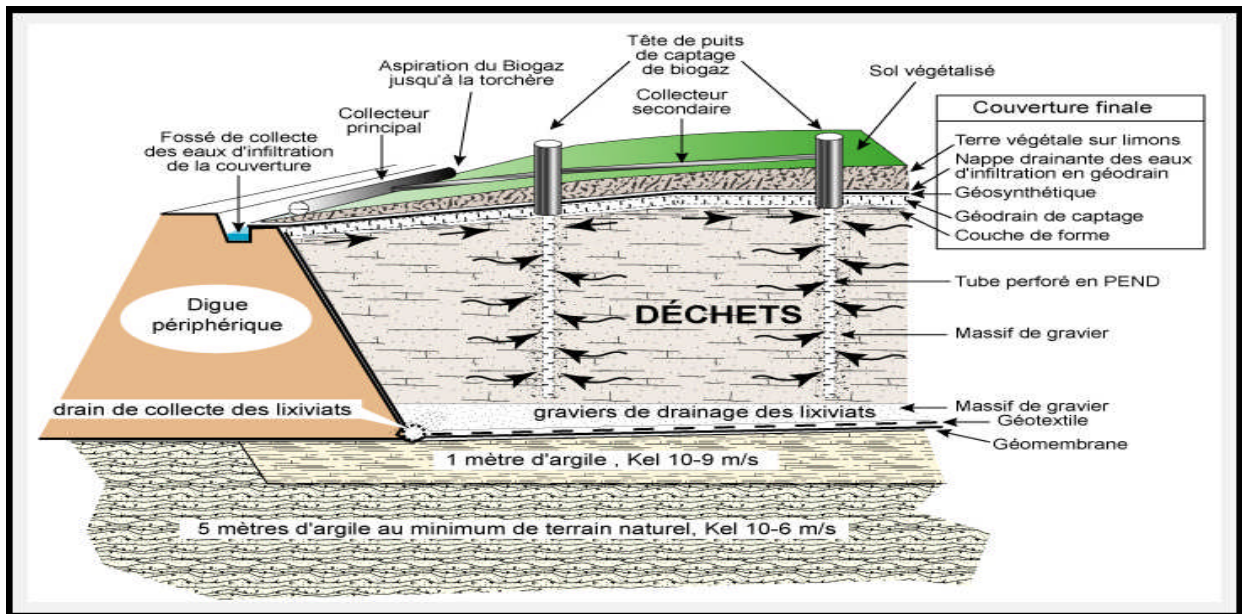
4 : coupe schématique d'un casier d'enfouissement (ENVAM 2008)
